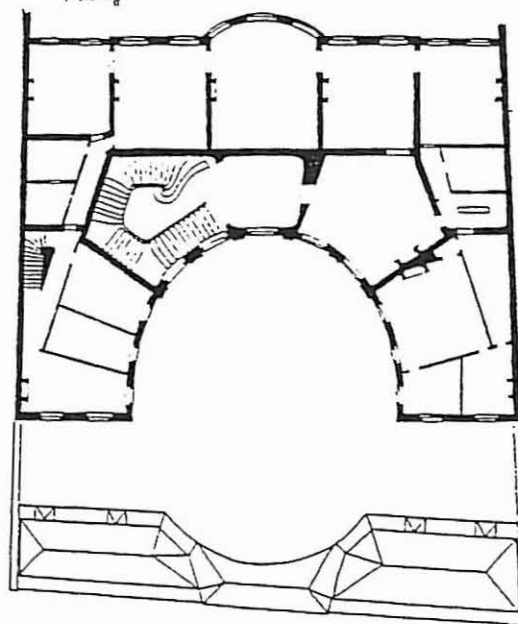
(CIII) Hôtel Amelot, rue Saint-Dominique. Boffrand. 1695. Plan du premier étage.
